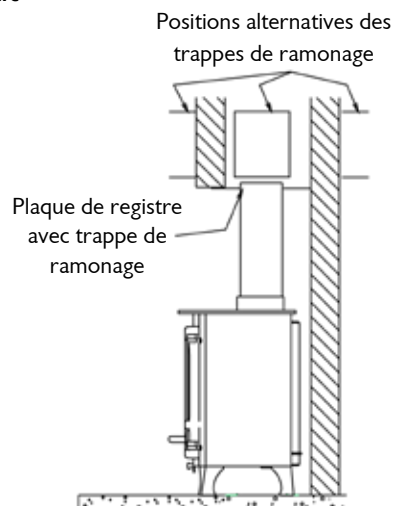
Plaque de registre horizontale avec branchement de conduit de fumée vers le haut
